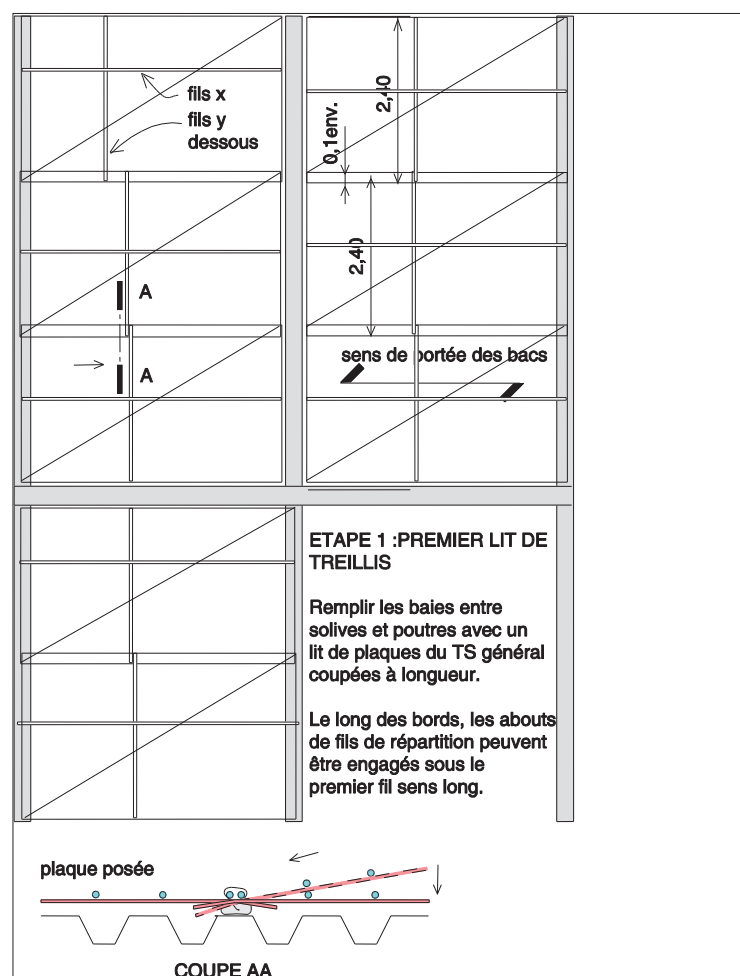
Mise en place du ferrailage dans la dalle – phase 1
